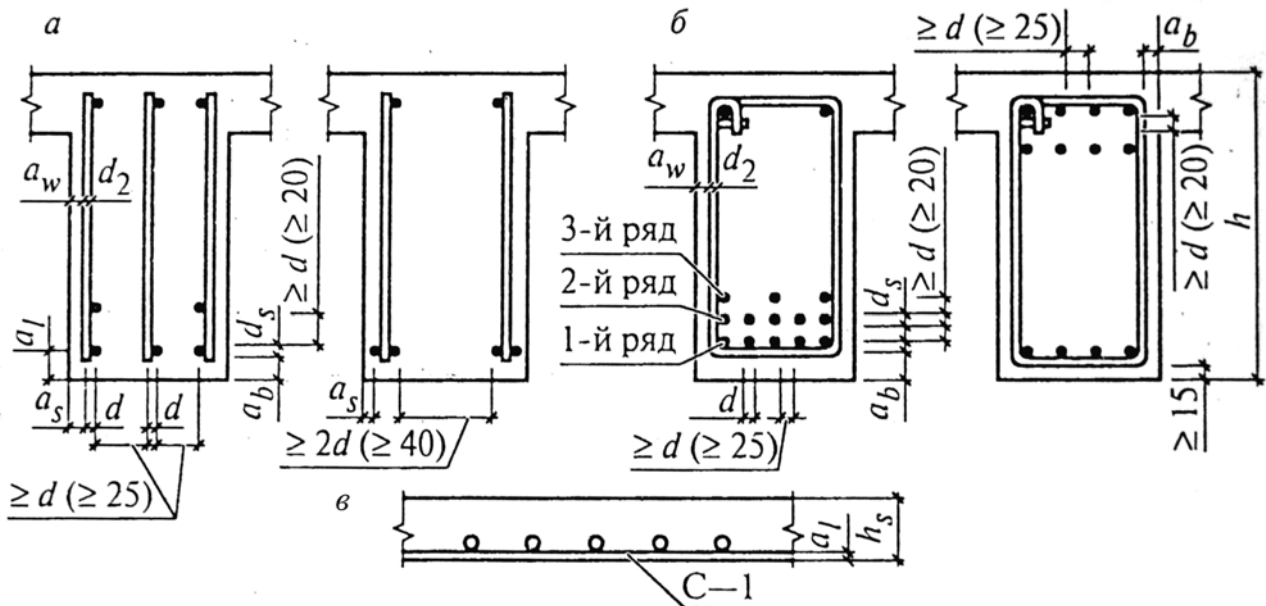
Расположение продольной арматуры в поперечном сечении балки:
